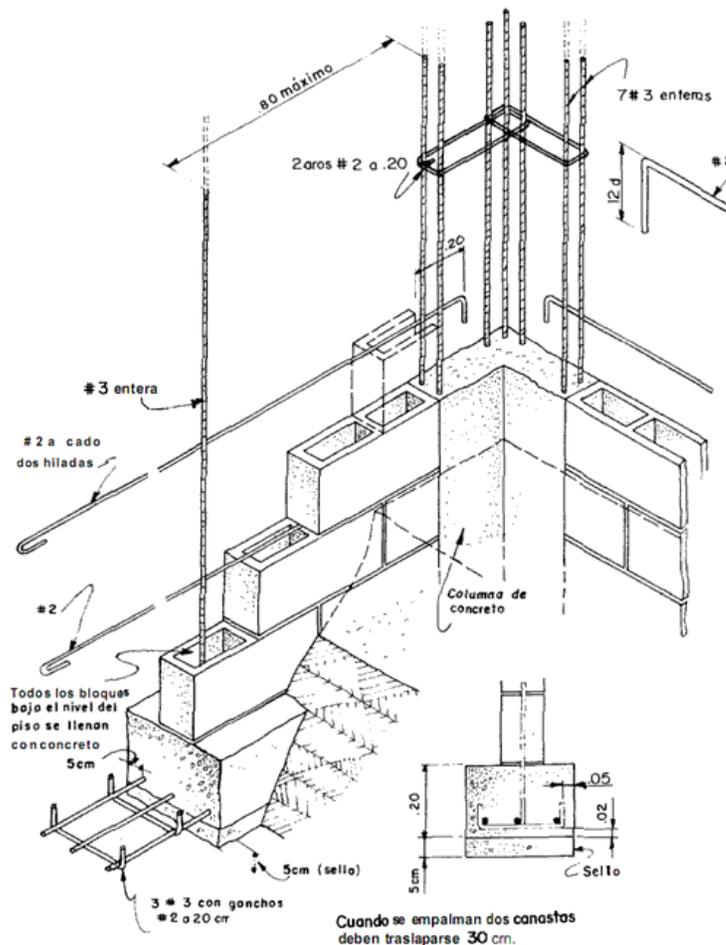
Refuerzos verticales y horizontales del sistema de mampostería armada.
